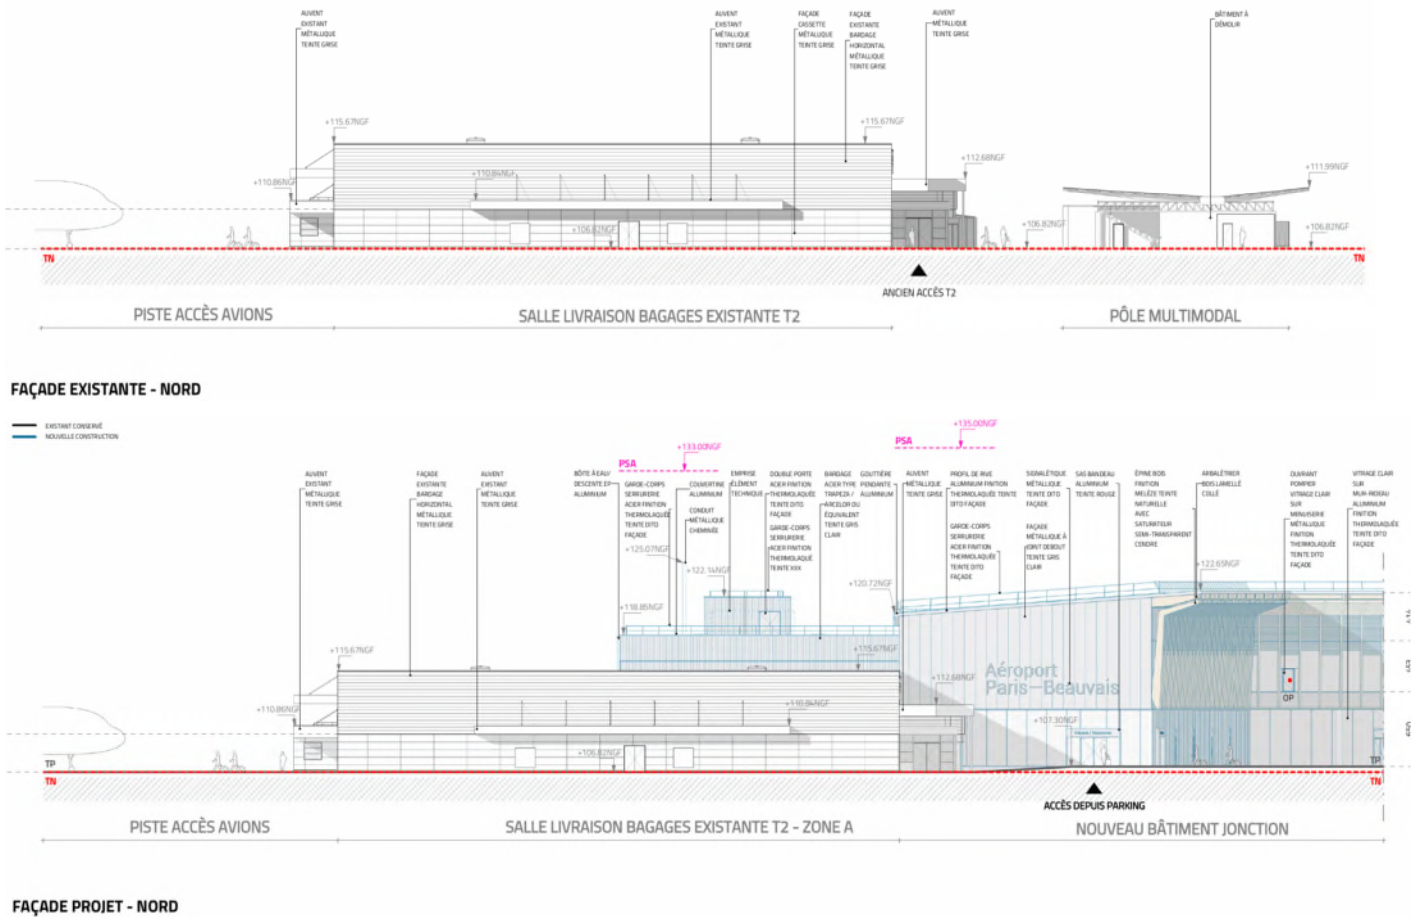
Coupe de la façade Nord existante et en projet (source : PC 2025)
